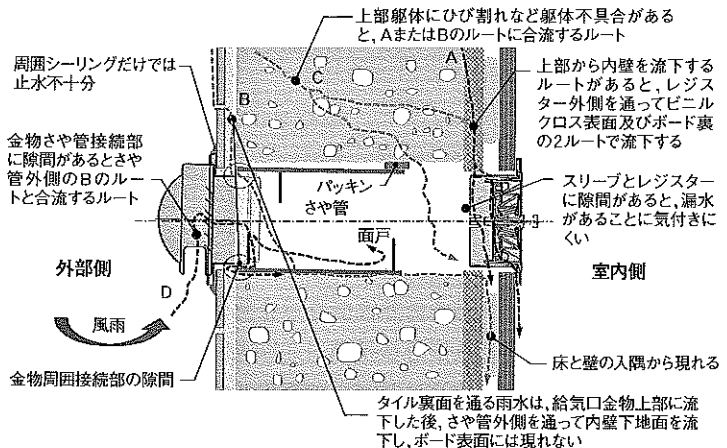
給気口回りの施工状態と貫通部の漏水ルート図
